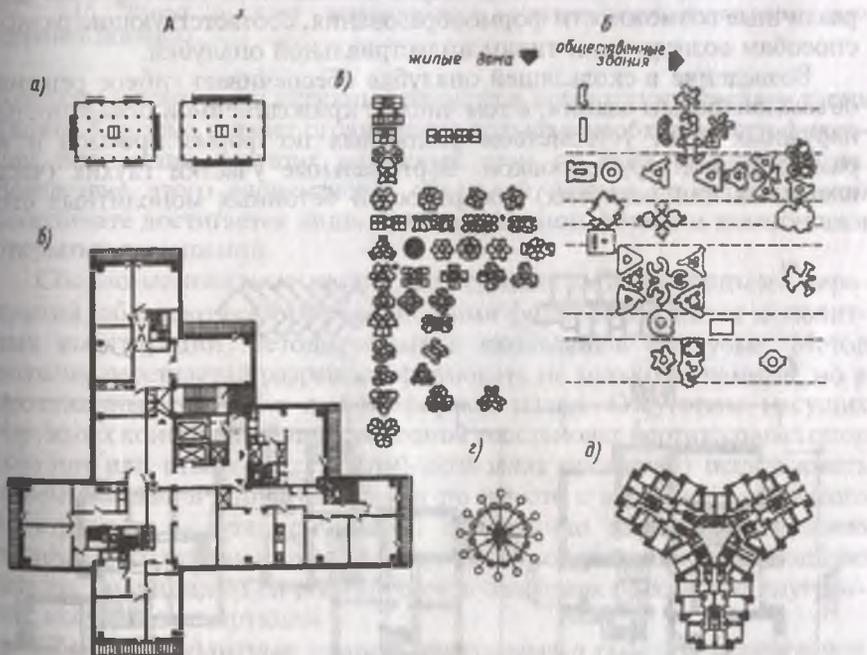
Схемы и примеры планировочной структуры каркасно-панельных (А) и каркасных (Б) зданий, возводимых методом подъема перекрытий: а — схемы поэтажных планов дома с чередующимся расположением балконов (МНИИТЭП); б — план типового этажа 20-этажного дома (МНИИТЭП); в — схемы планов жилых и общественных зданий, возводимых методом подъема перекрытий; г — схема плана 17-этажного дома в г. Киеве (КиевЗНИИЭП); д — то же, в г. Ереване (ВПЭКТИ)
